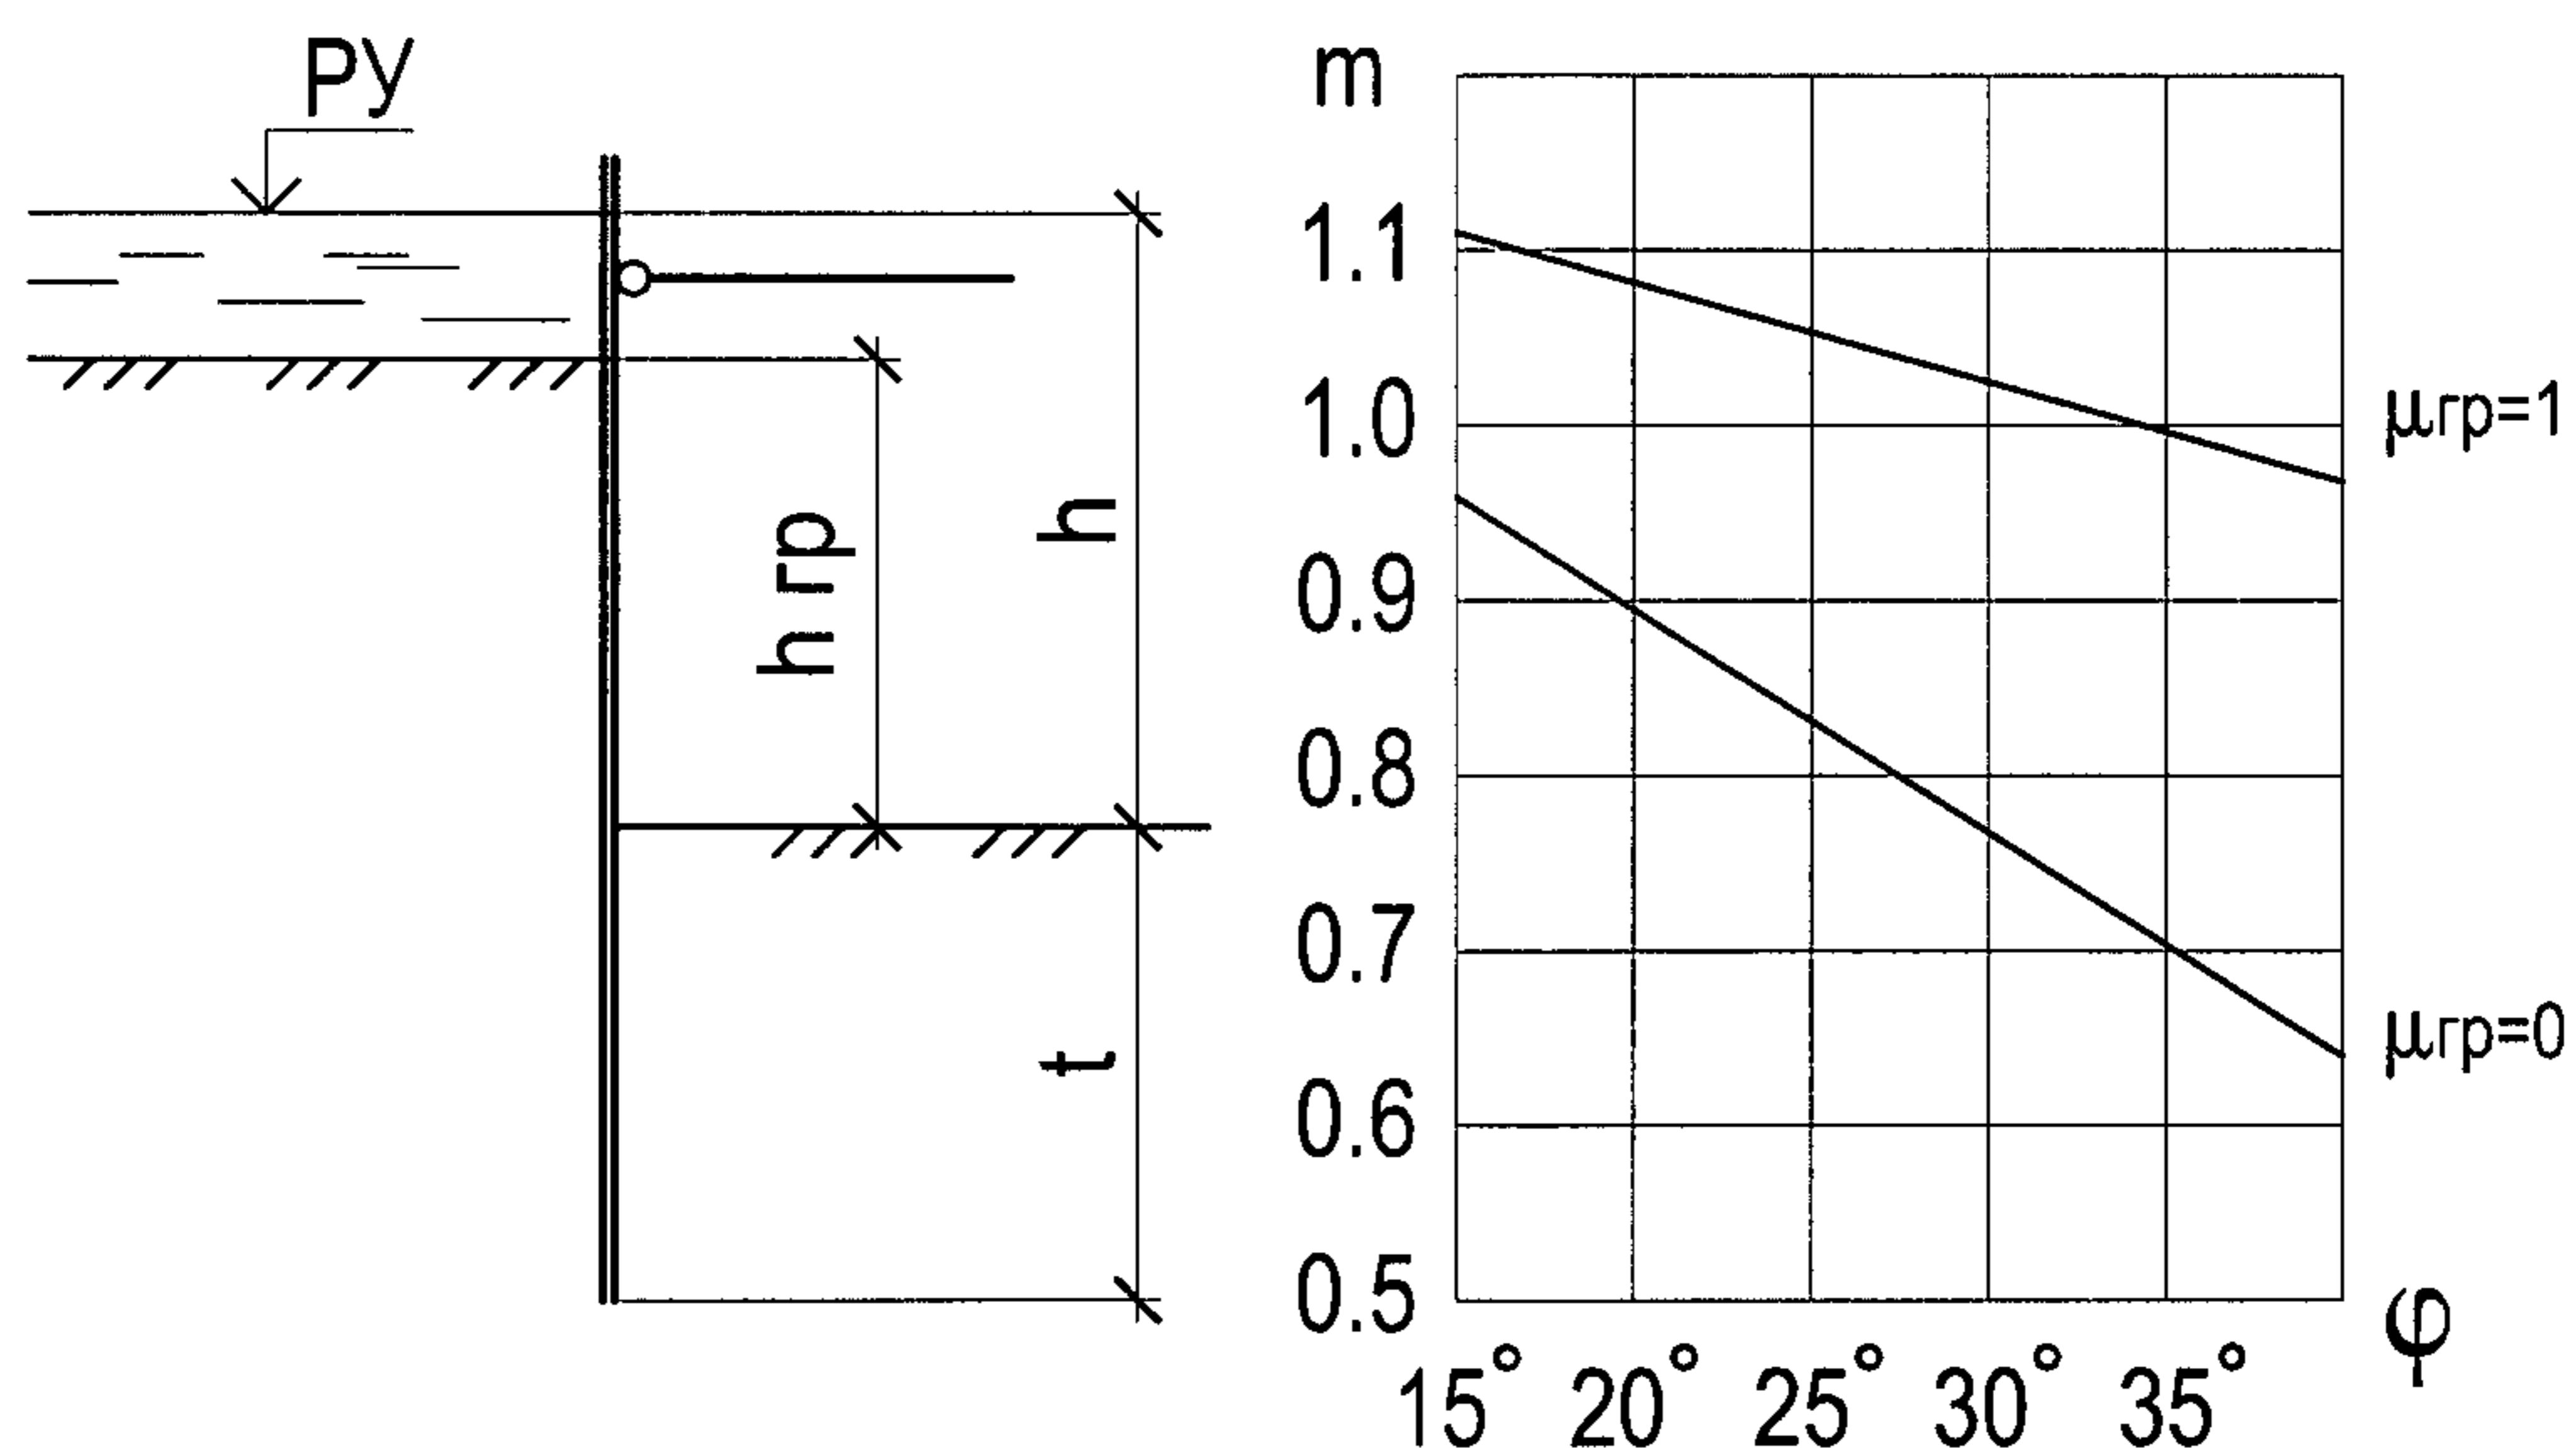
Схема и график для определения коэффициента условий работы в расчете устойчивости шпунтового ограждения на открытом водотоке при одном ярусе распорных креплений
